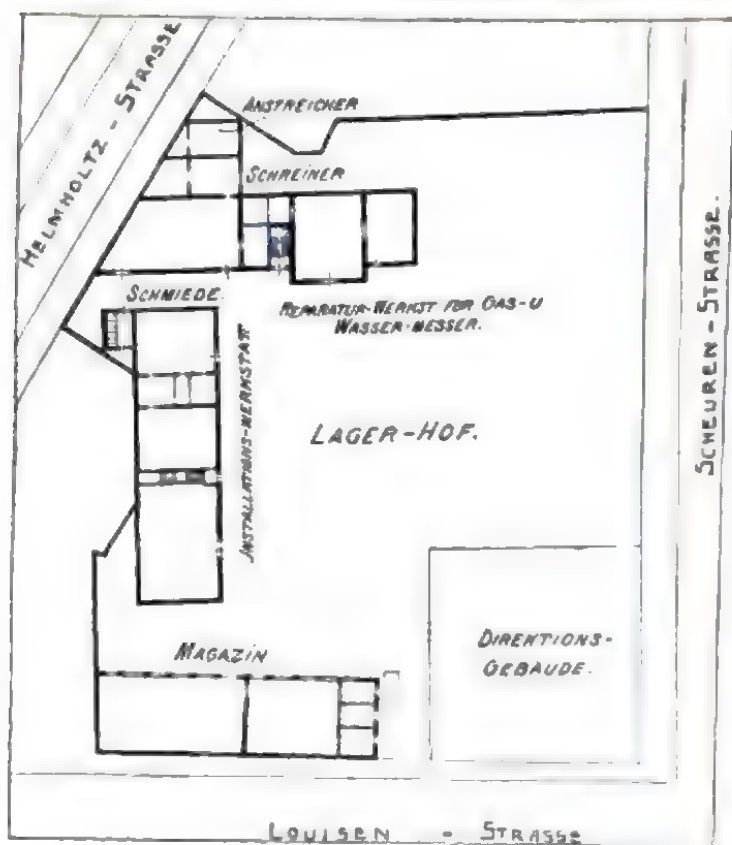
Lageplan des Direktionsgebäudes und der Werkstätten.
